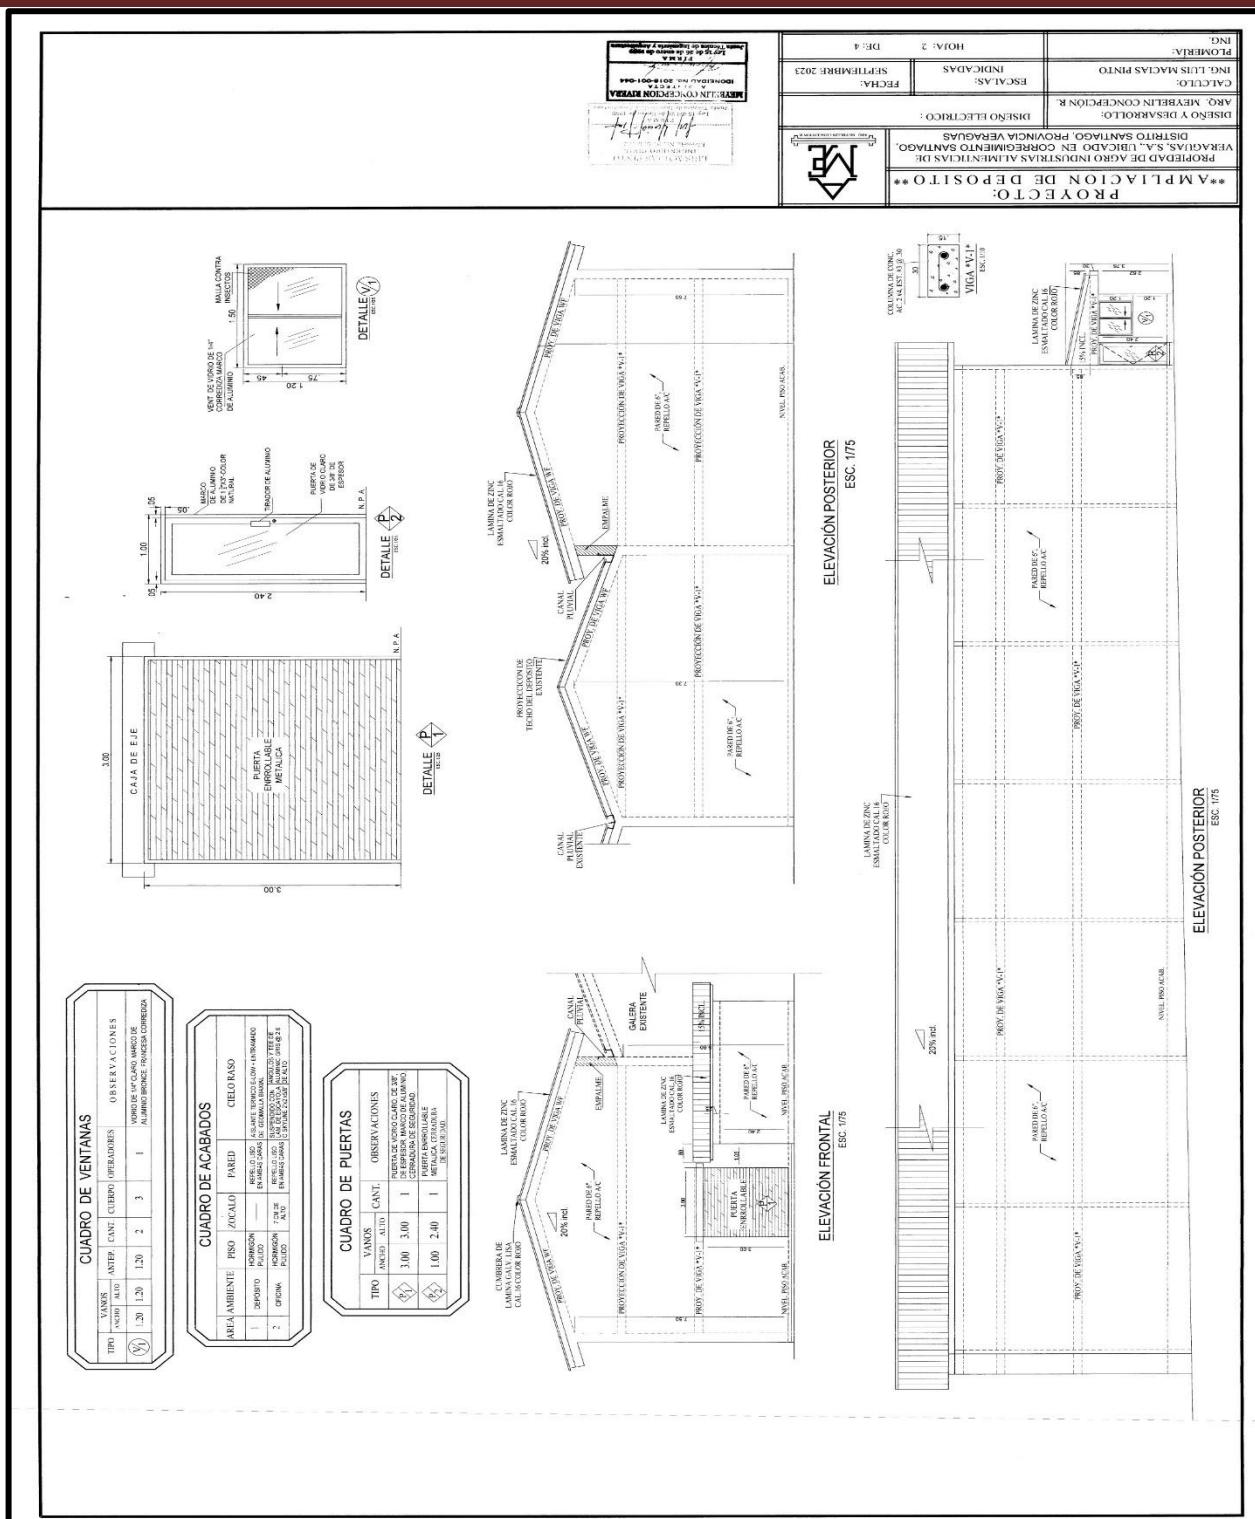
Planta arquitectónica (elevaciones frontales y posterior).
